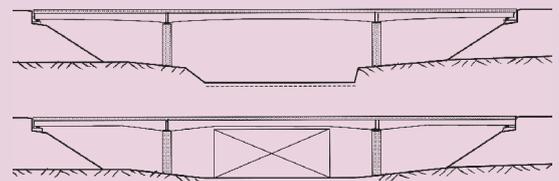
Ouvrages avec tabliers de hauteur variable sur toute leur longueur
